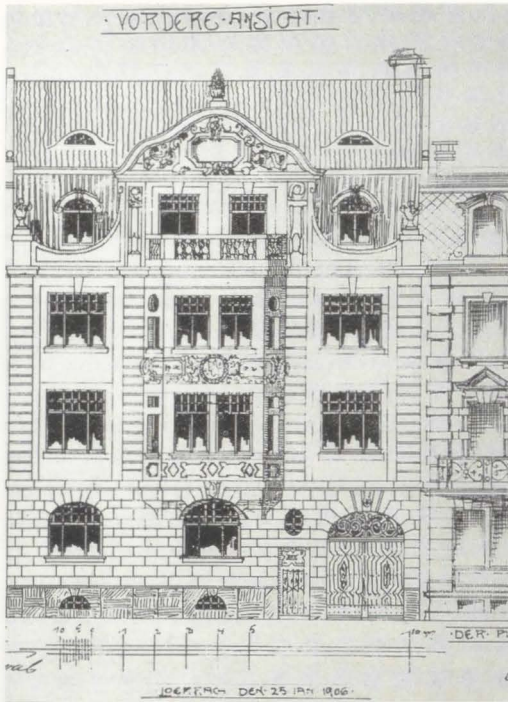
Bauplan Belchenstr. 17, Stadtarchiv Lörrach
